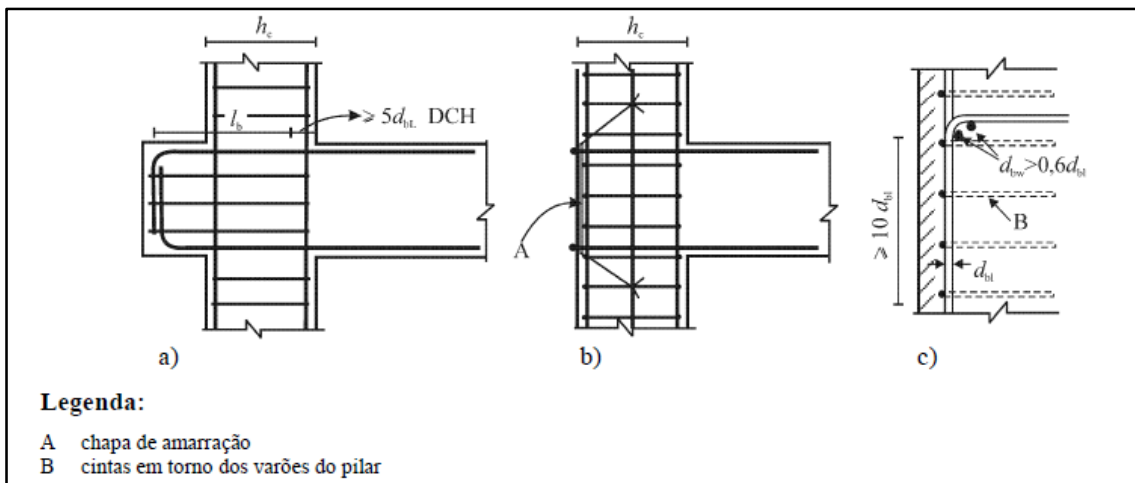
Disposições complementares para a amarração nos nós viga-pilar exteriores [7]
